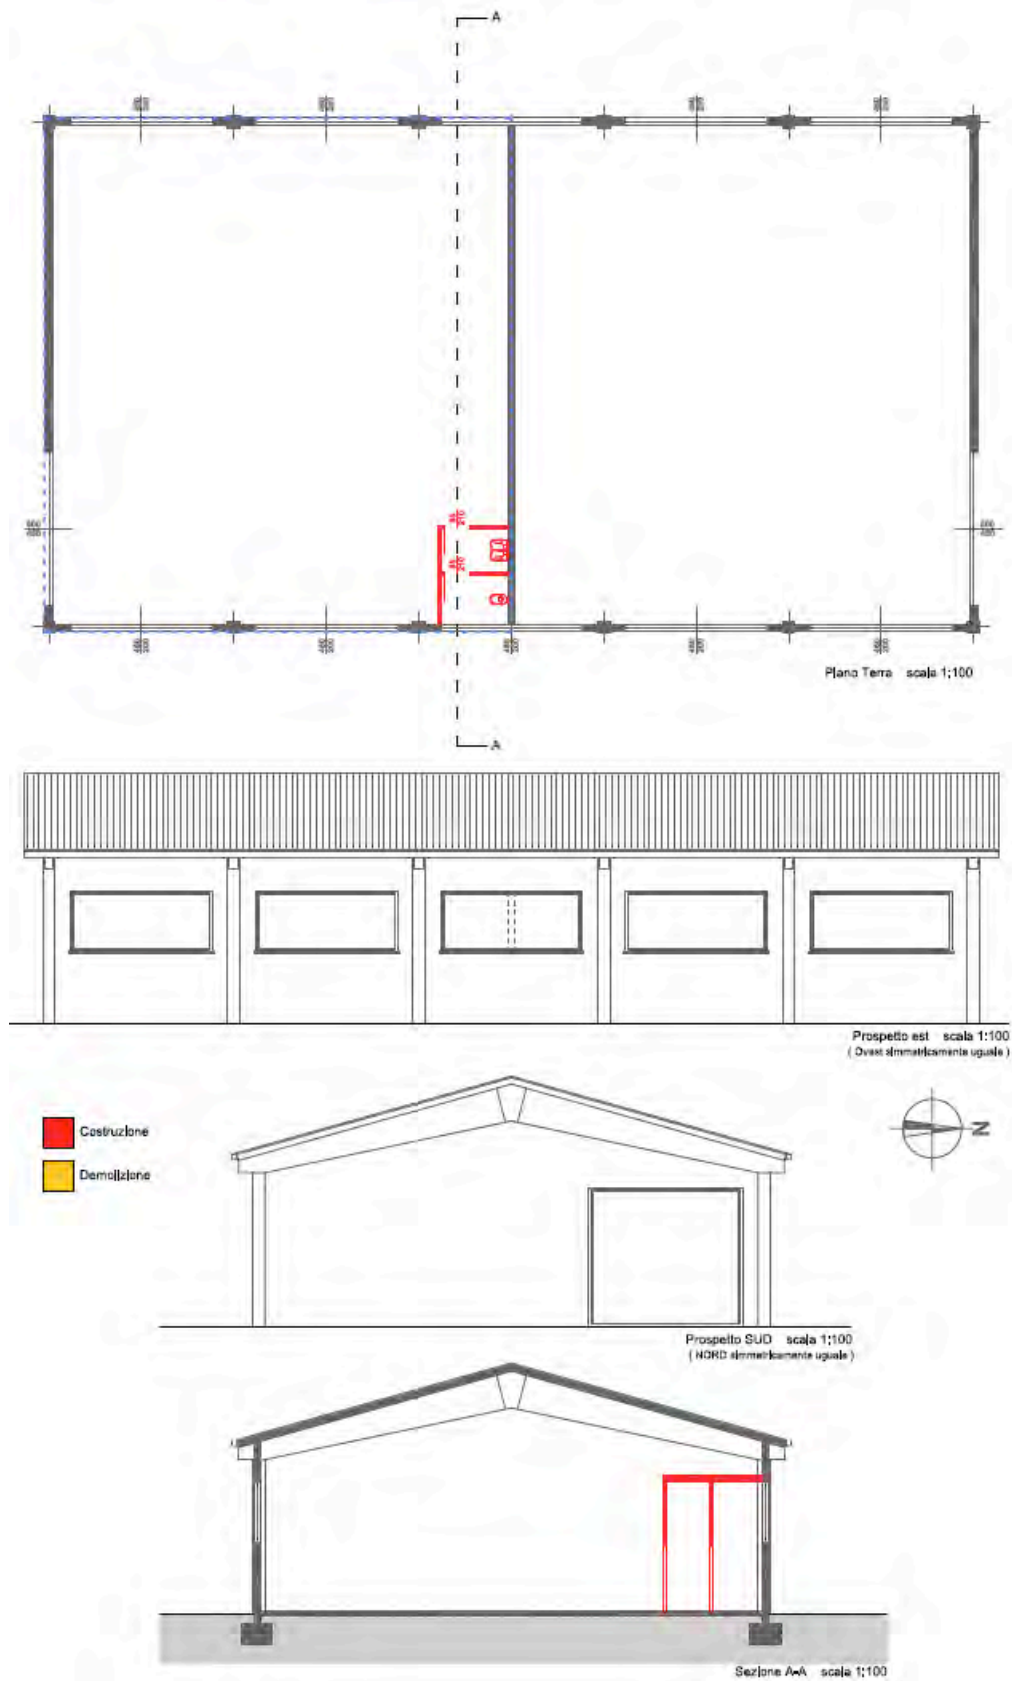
Sovrapposizione stato di fatto e di progetto: planimetria prospetti e sezione - estratto della Tav. 3 di progetto
